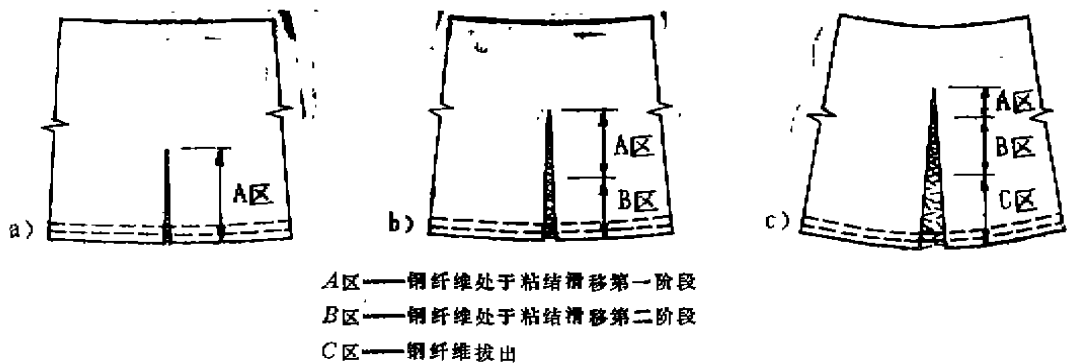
钢筋钢纤维混凝土梁受拉区裂缝中纤维的受力分区
